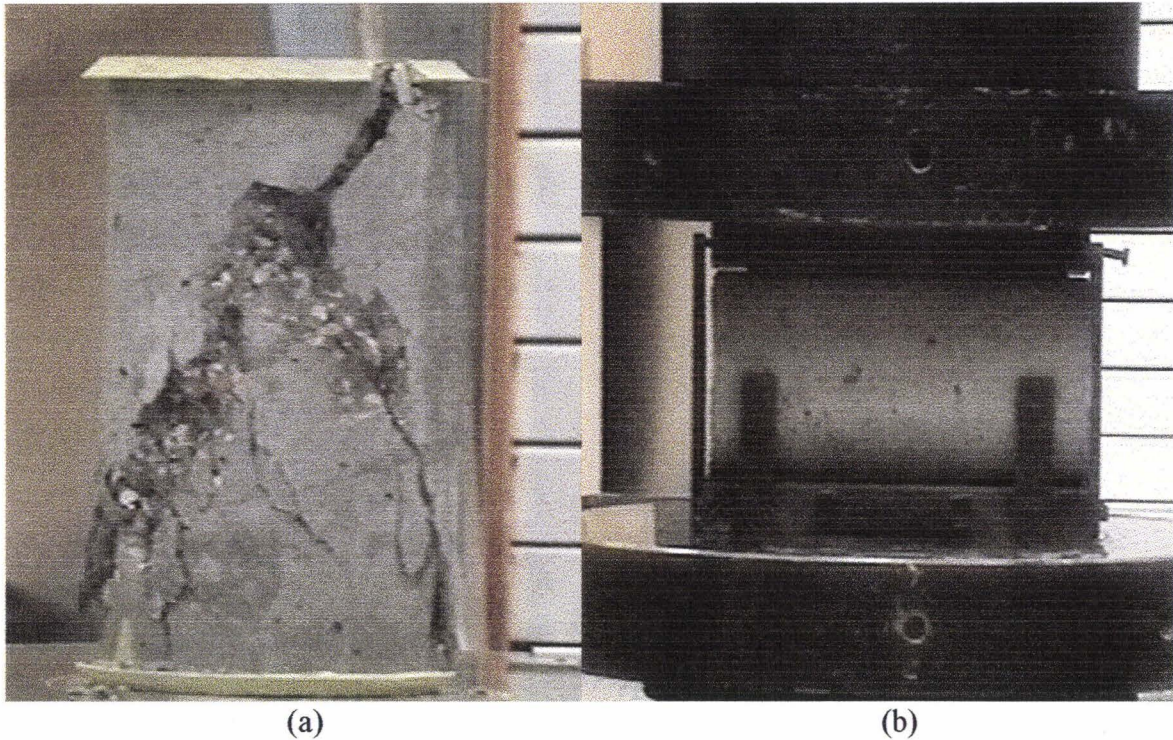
Essais sur les éprouvettes cylindriques (a) mode de rupture du béton de fibres en compression (b) essai de traction par fendage
